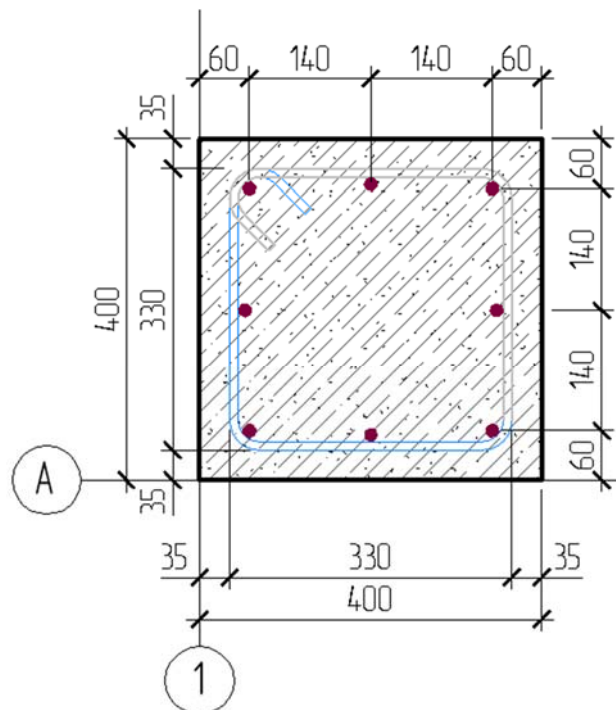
Схема розміщення арматури в перерізі залізобетонної колони
